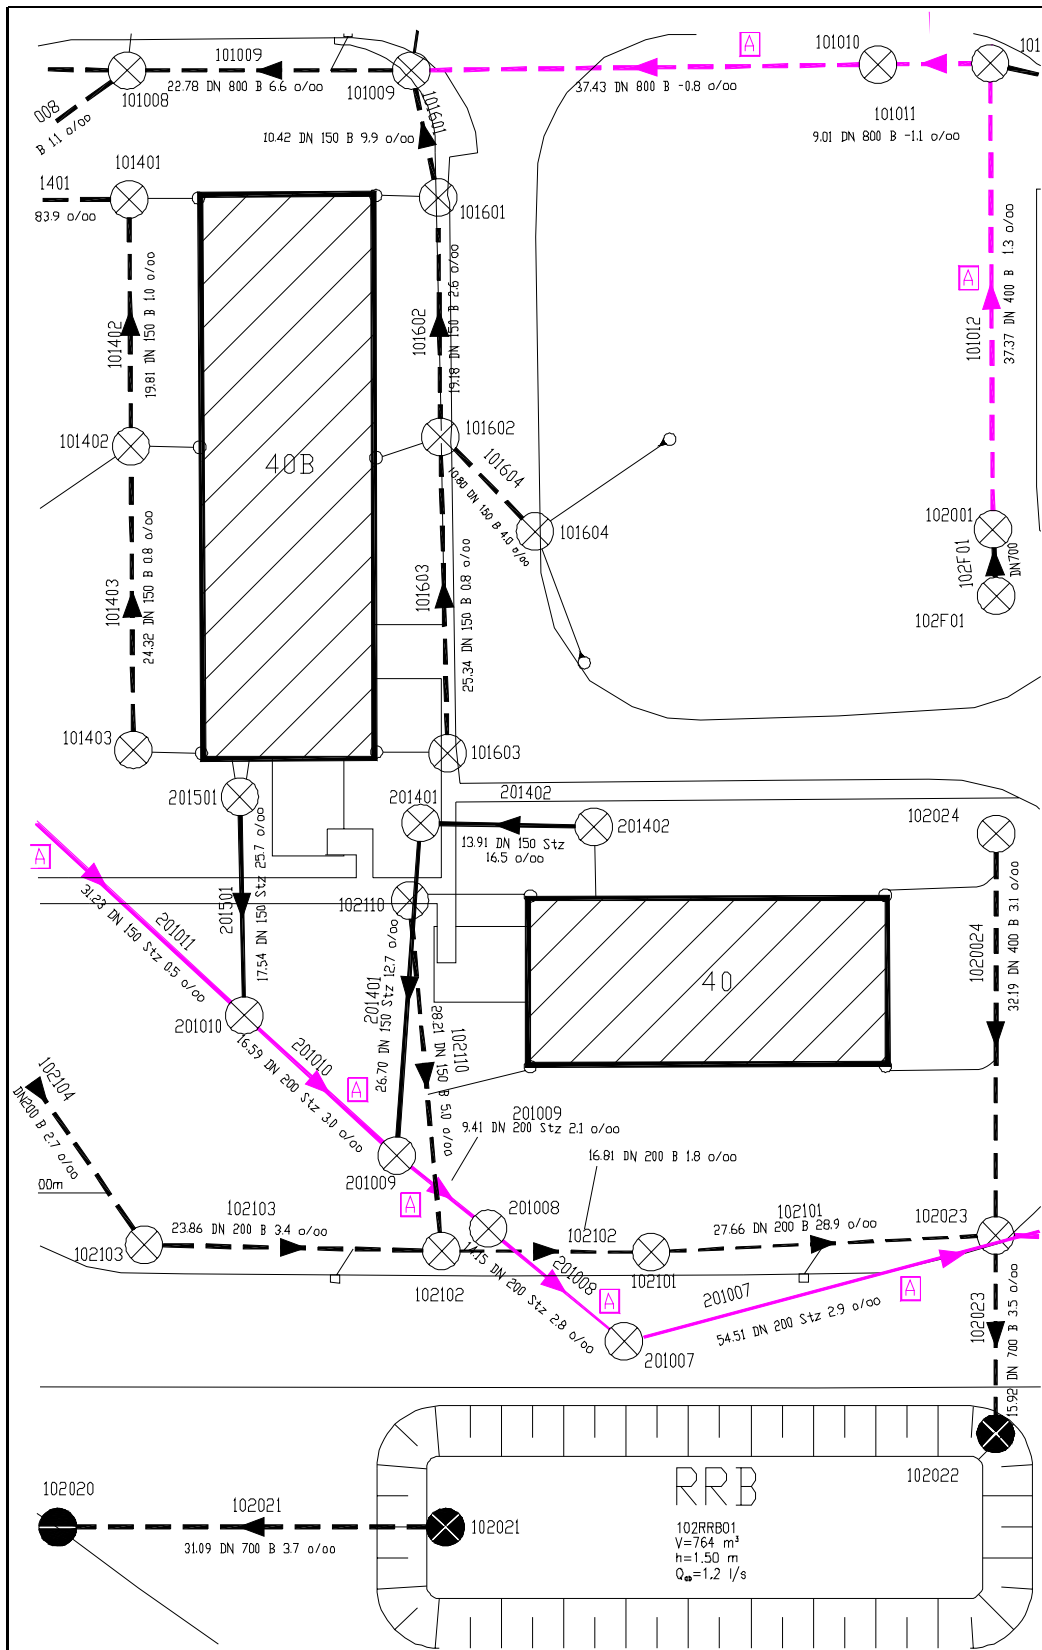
14 Beispielplan: Lageplan "Ablagerungsgefährdete Kanäle"
